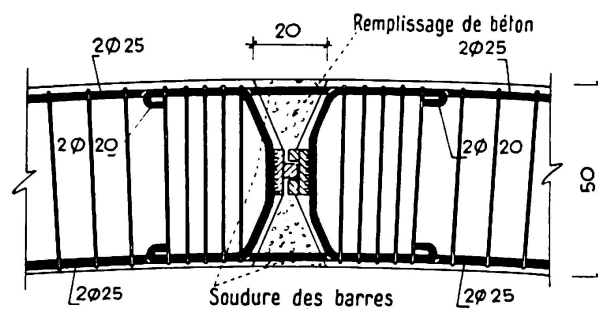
Articulation de clef provisoire de montage dans un arc préfabriqué.
